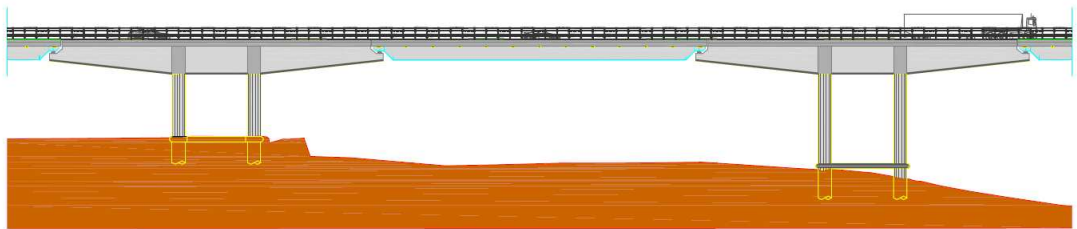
Estratto del prospetto longitudinale dell'impalcato di progetto
